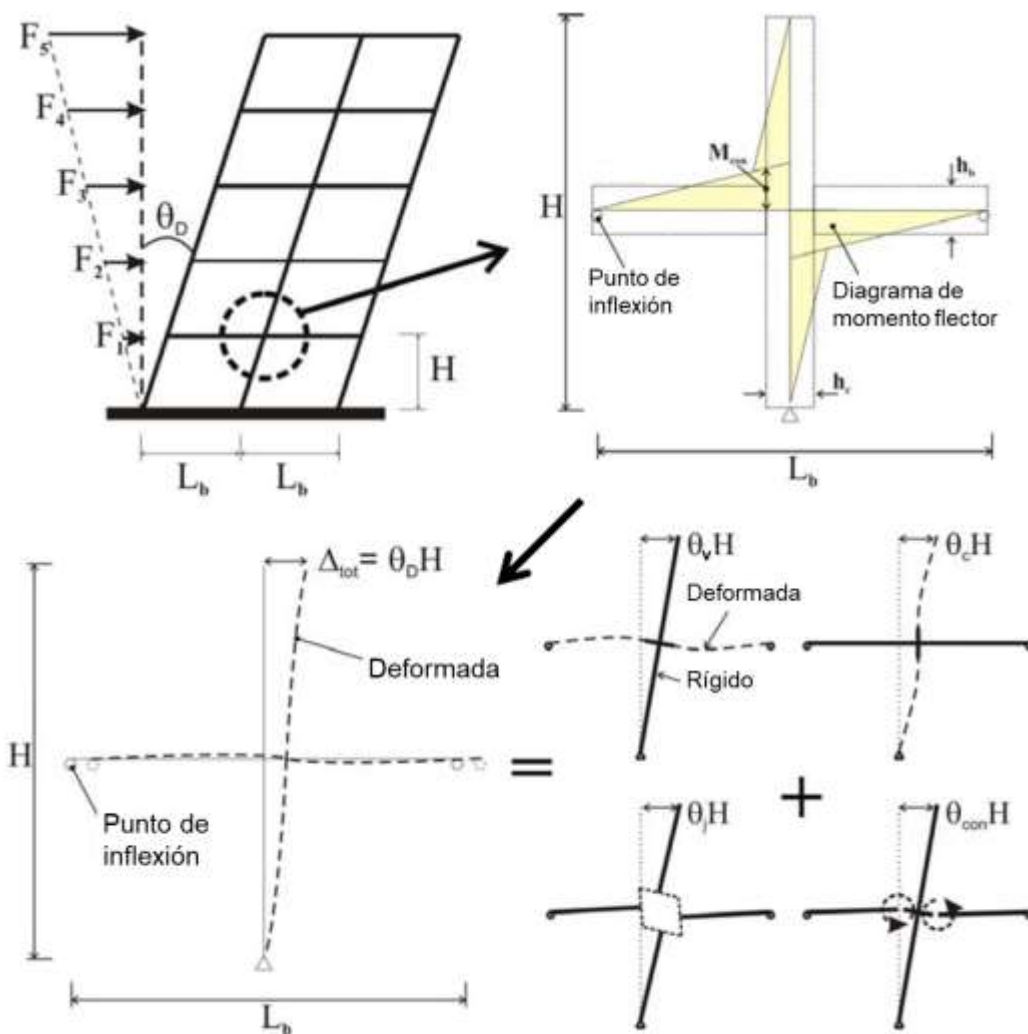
Representación de deformaciones elásticas en la conexión viga-columna en pórtico postensado (Adaptado de Newcombe, 2011).
